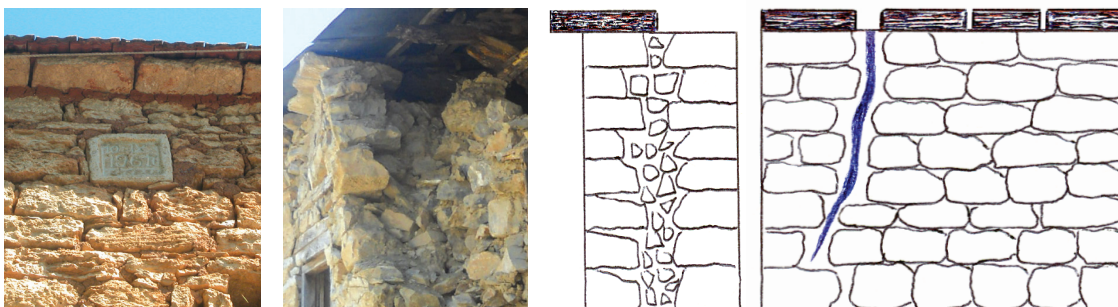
Variante de la corniche du toit : Pierres plates juxtaposées (a) et reposant sur la couche extérieure du mur (b) ; Schémas de la section du mur (c) et de son élévation montrant la fissuration verticale favorisée par l'écartement des pierres de la corniche (d).
